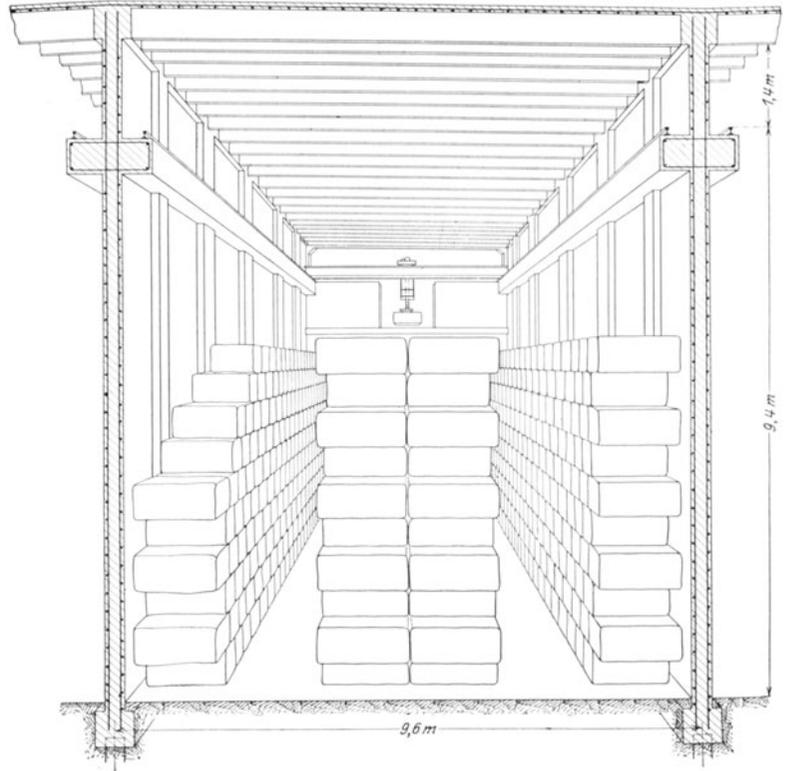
Eine Zelle des Baumwollspeichers und Stauweise.
